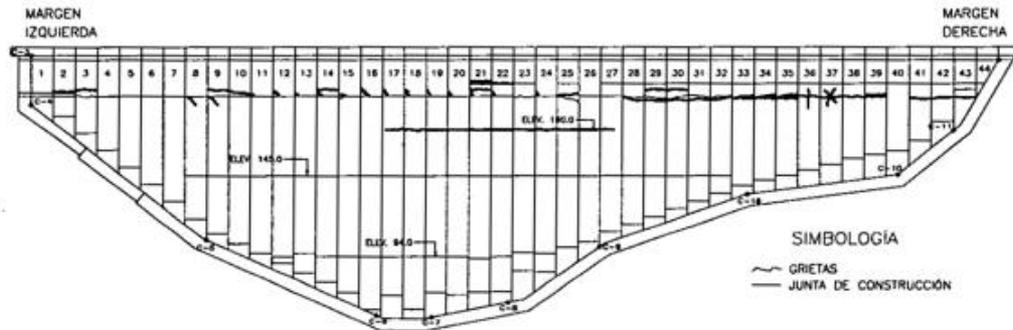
Localización de las grietas en la cara de concreto.
